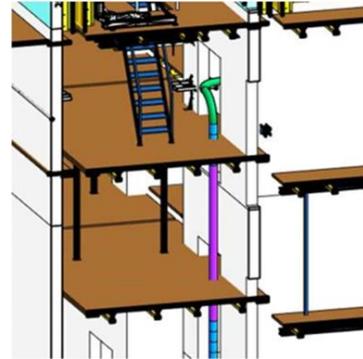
Zoom sur la position des conduitex dans les planchers du coffrage
